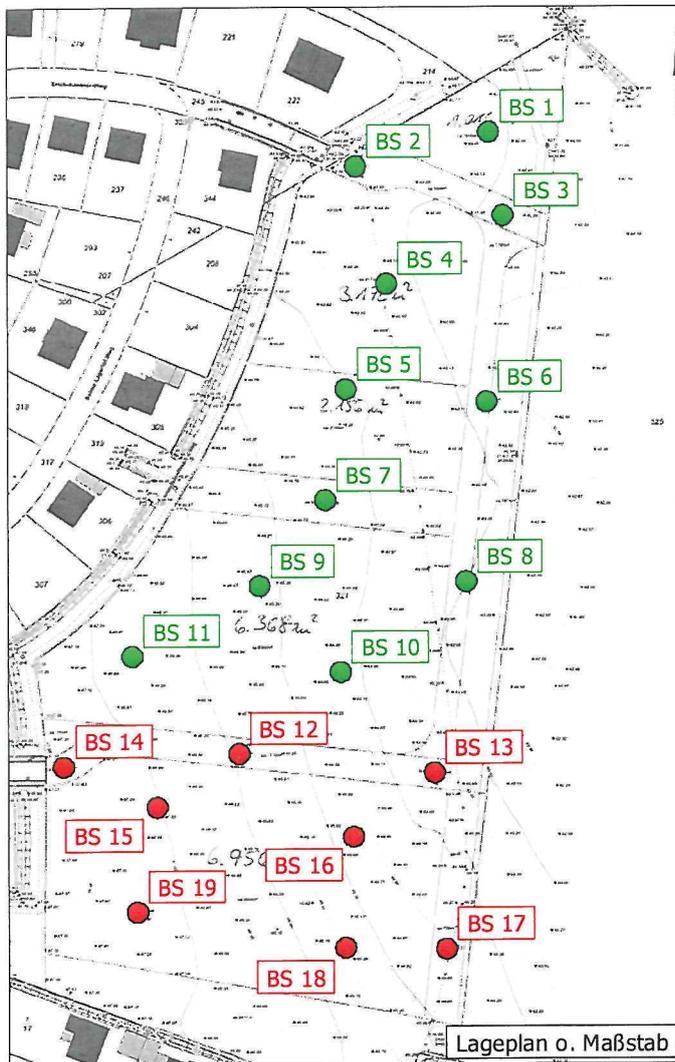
Lageplan Anl. 1.1 (o. M.)
